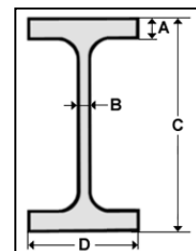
Détail n°2 Poutre IPE, Source : auteurs
